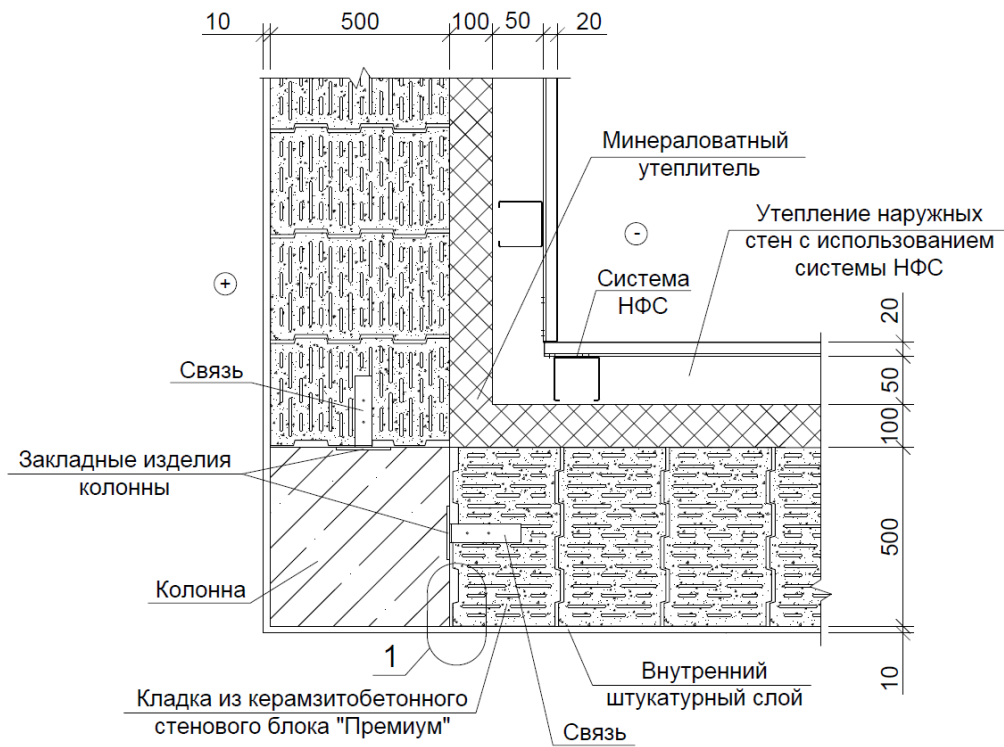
Узел крепления наружной стены к монолитной колонне.
